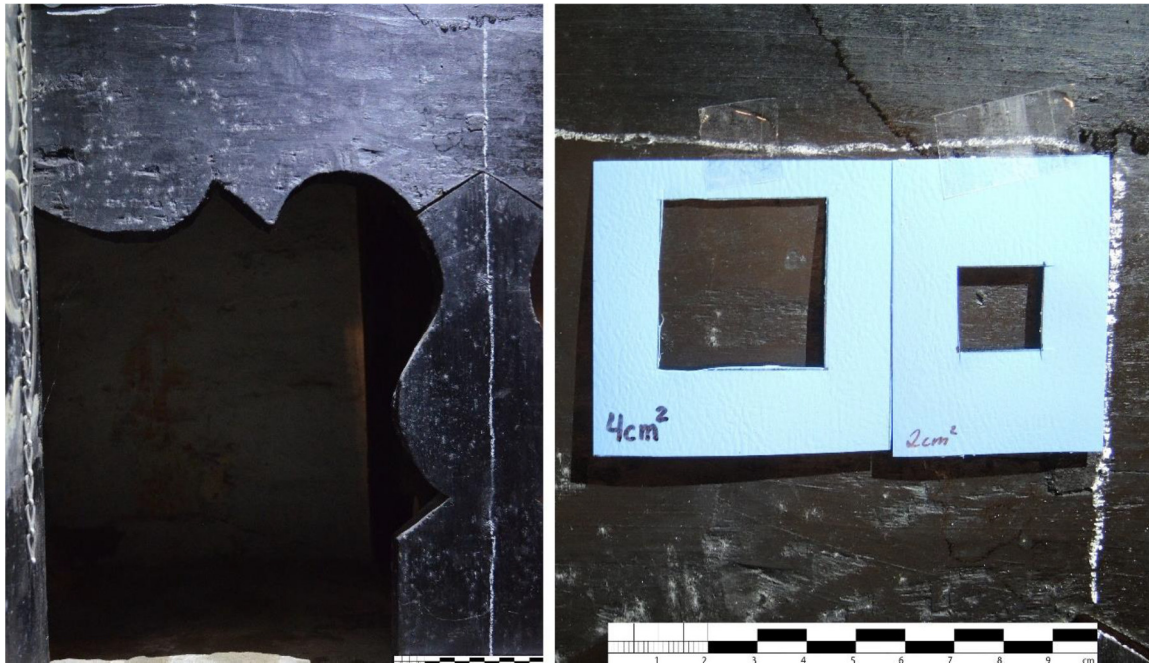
Fotocollage: Schlosskapelle Zelle, Prieche 06 im EG; links: Referenzfläche EG11; rechts: aufgelegte Schablonen mit Beprobungsflächen für die Samtstempelprobe (4 cm²) und die ATP-Messung (2 cm²)
